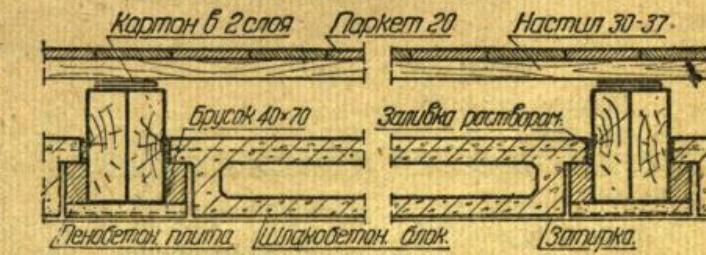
Междуетажное перекрытие Техпроекта с накатом из шлакобетонных блоков.
